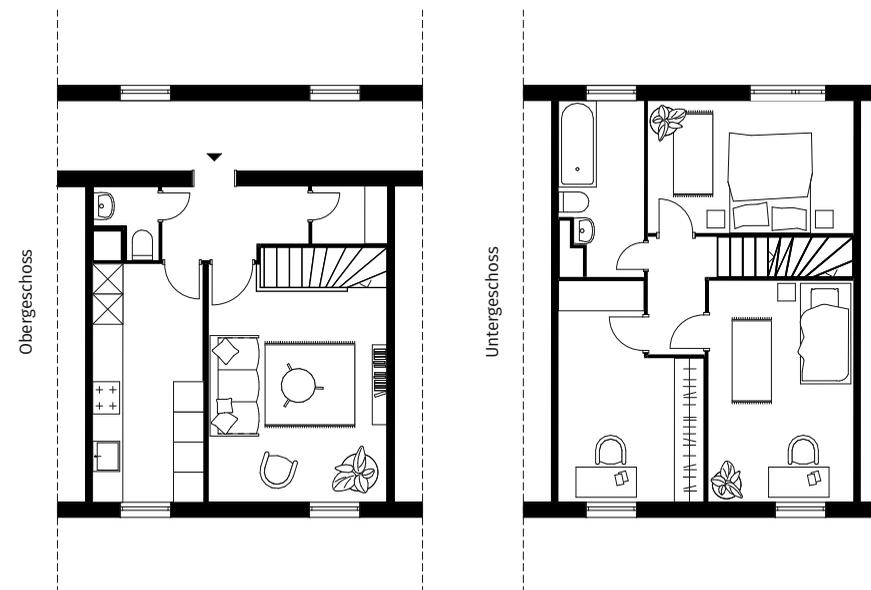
Grundriss, Maisonette-Wohnung Bauteil D
